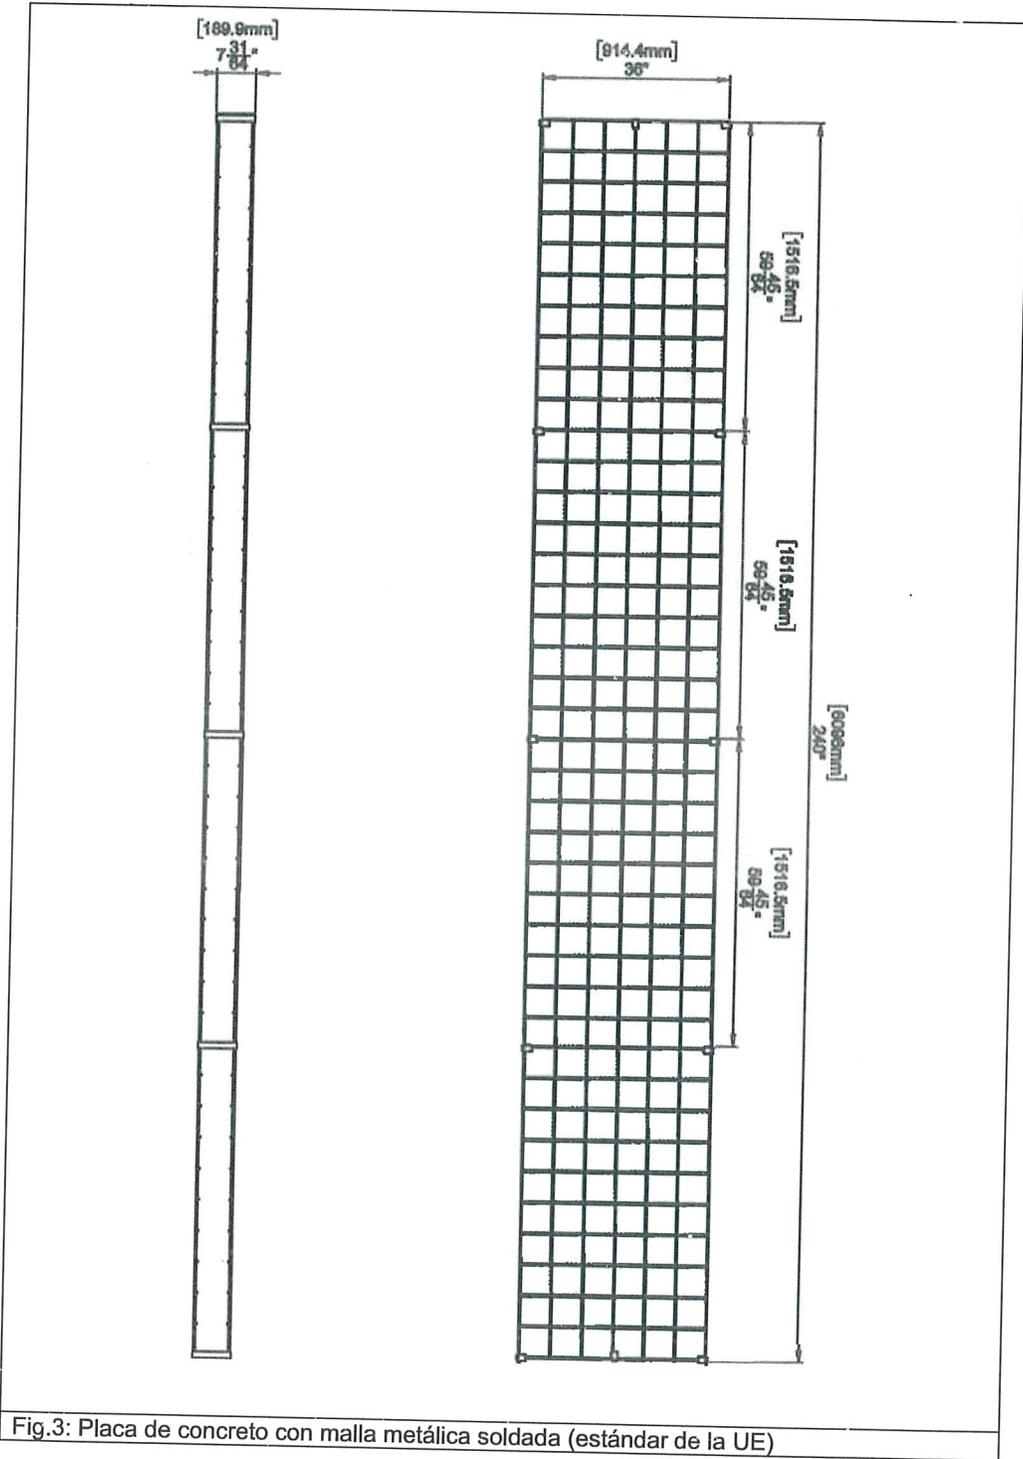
Placa de concreto con malla metálica soldada (estándar de la UE)
